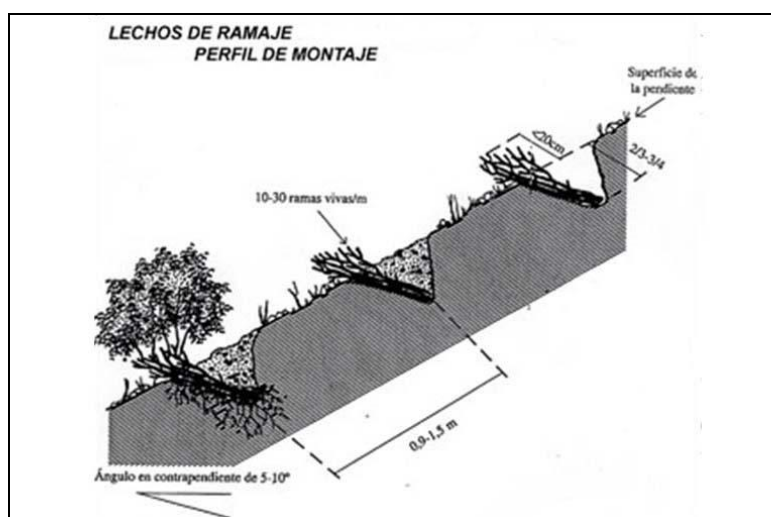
Perfil de construcción de lechos de ramaje en ladera. Fuente: NTJ 12S PARTE2, 1989.
